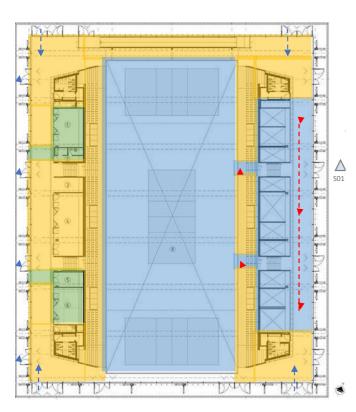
Zonas en 1ra planta, Coliseo: Voleibol Fuente: Plataforma Arquitectura Elaborado por: Autor
